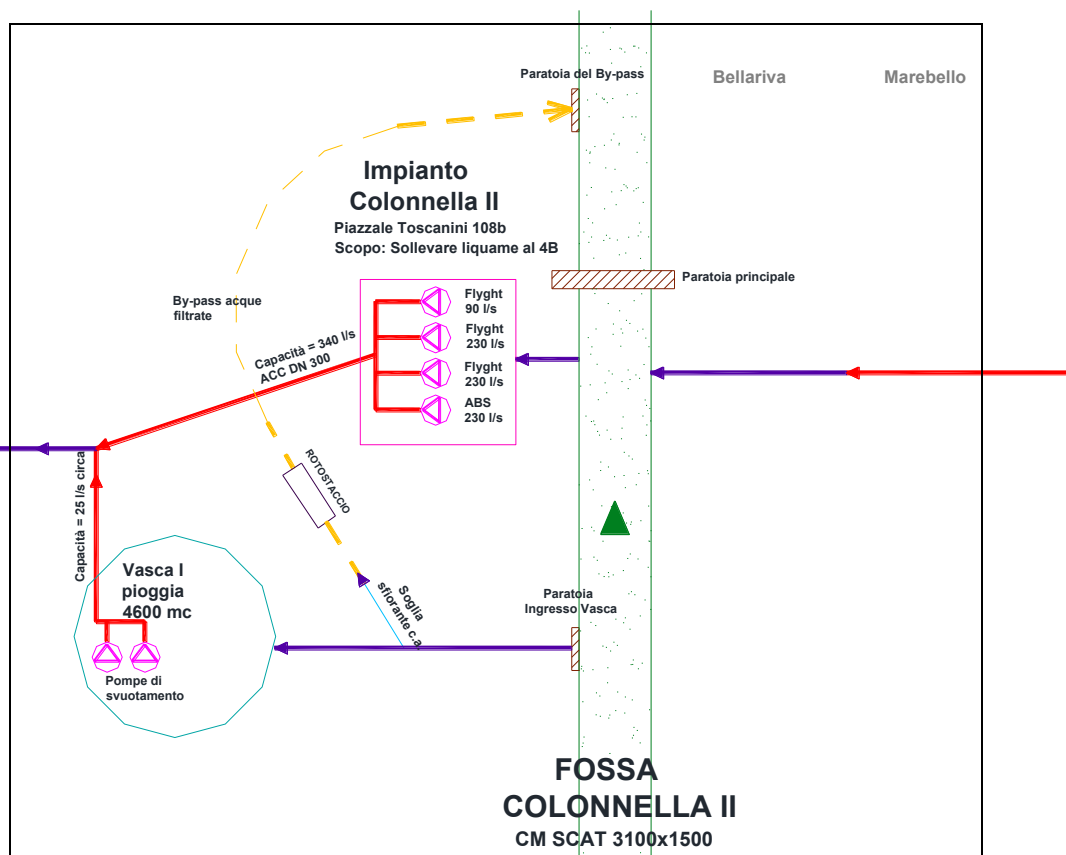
Schema planimetrico del tratto terminale della fossa Colonnella II
